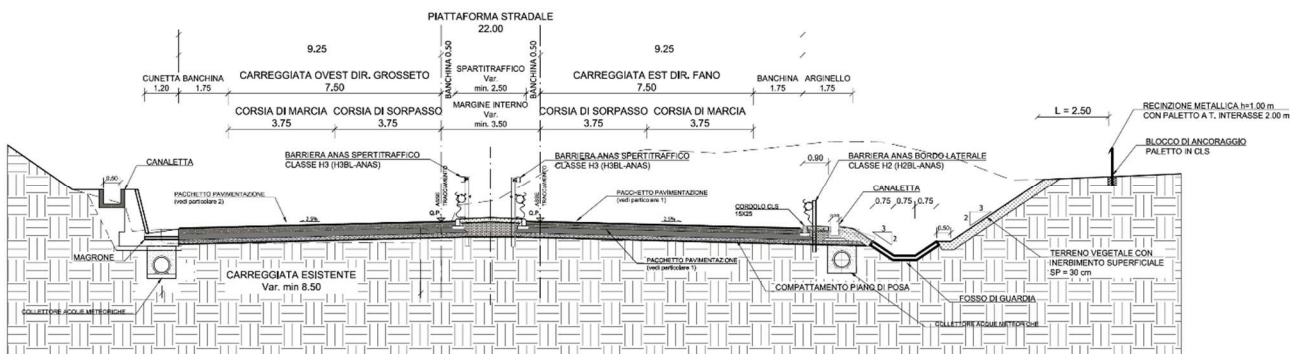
Sezione tipo in trincea in rettilineo con scavo laterale e muro a margine
